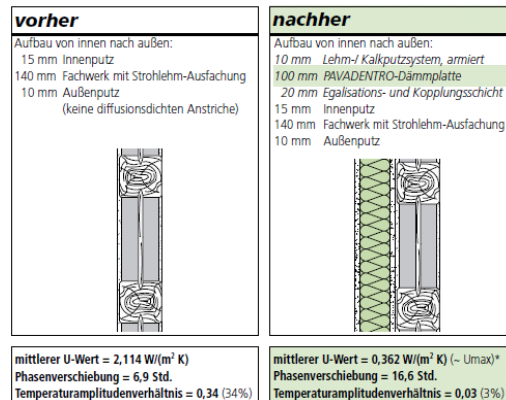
Konstruktionsbeispiele Fachwerk-Außenwand
